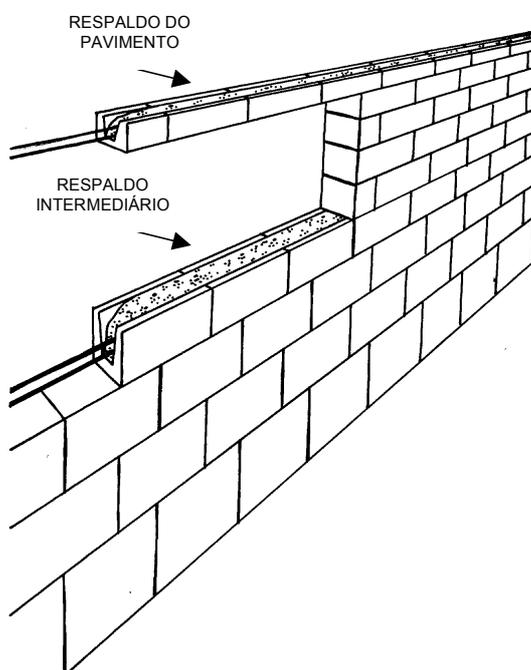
Respaldo intermediário e respaldo do primeiro pavimento
